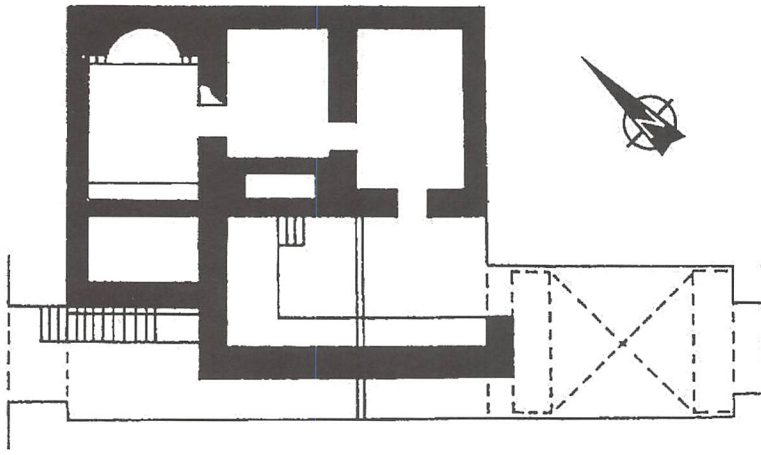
مسقط أفقي لحمام الصرح السراح.
